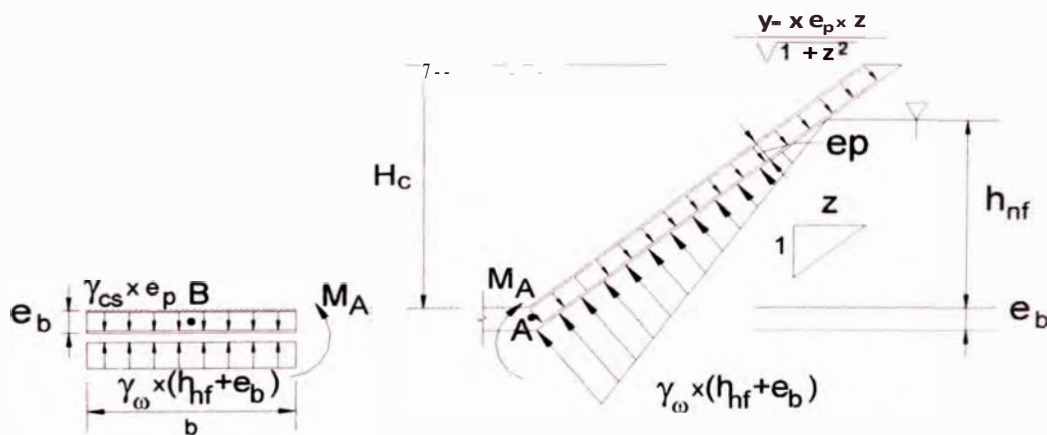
Cargas en Losa y Pared del Canal Trapezoidal: Caso 1
